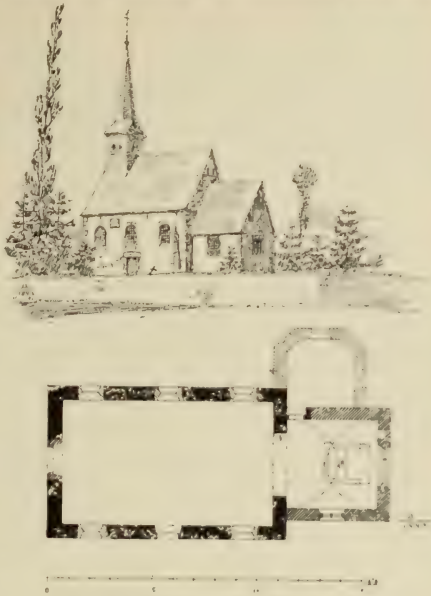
Heddinghoven Ansicht und Grundriss der Kapelle
